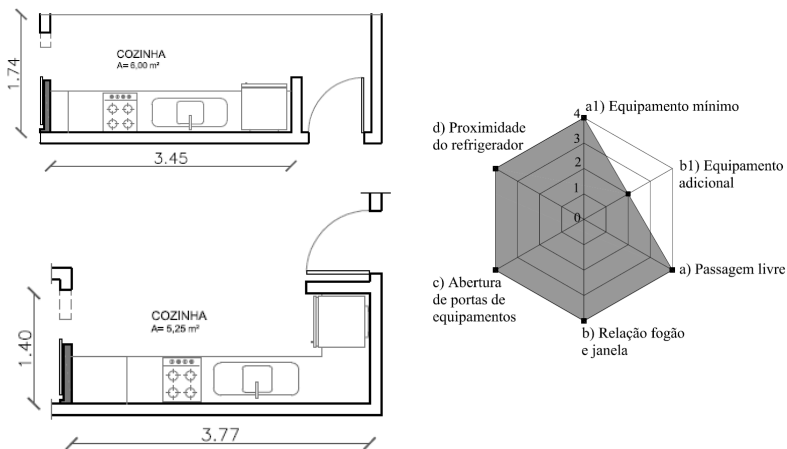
a) Planta baixa cozinha Tipo A. b) Planta baixa cozinha Tipo B. c) Modelo radar do cozinha Tipo A e Tipo B.
